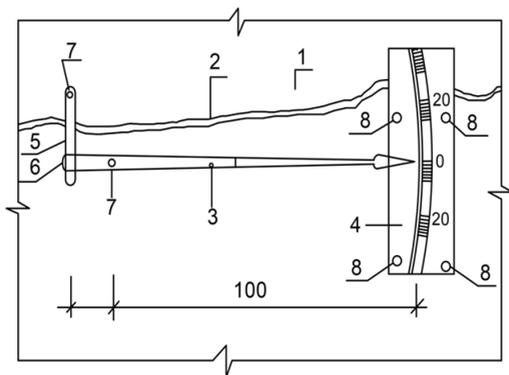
Стрелочно-рычажный маяк: 1 — строительная конструкция; 2 — трещина в конструкции; 3 — стрелка; 4 — мерная шкала, градуированная через 1 мм; 5 — планка; 6 — шарнирное крепление стрелки к планке; 7 — шарнирное крепление стрелки и планки к конструкции; 8 — крепление мерной шкалы к конструкции с одной стороны от трещины
